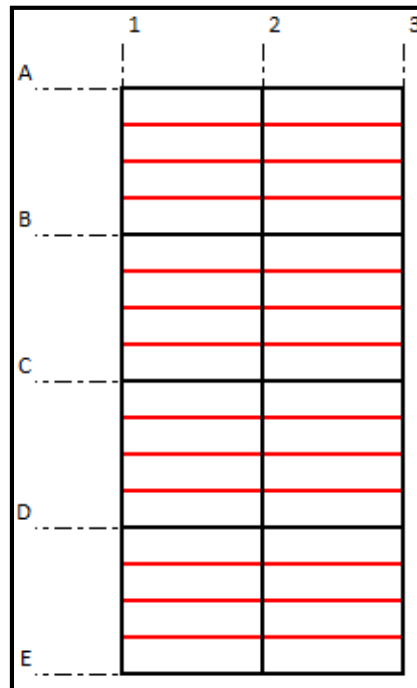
Planta, vigas secundarias con Pórticos arriostrados.
